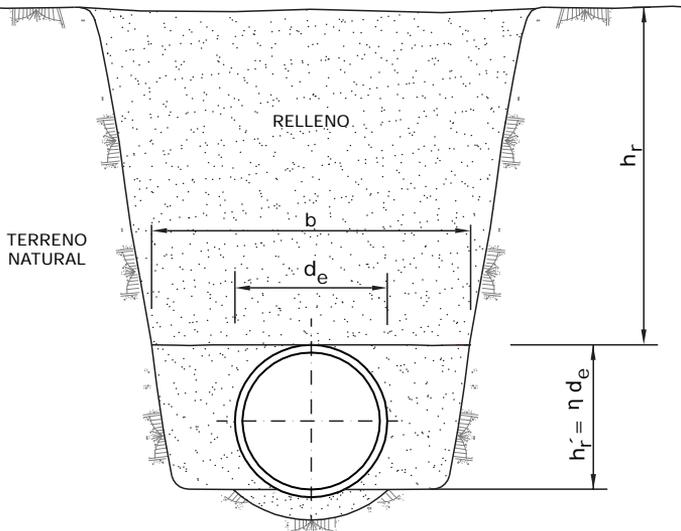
Esquema de la tubería colocada en zanja.
